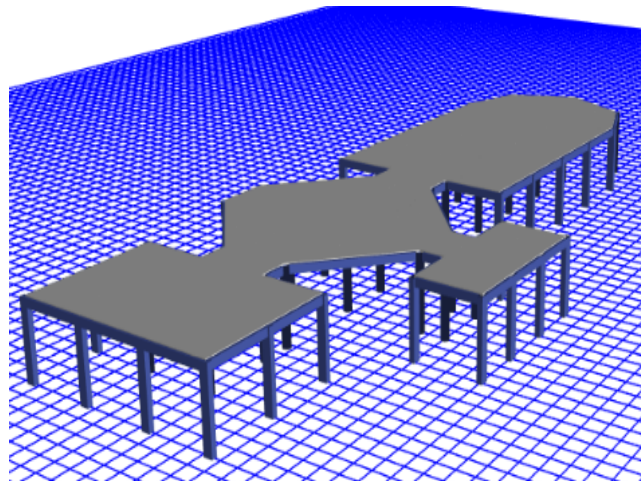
Modelo en ETABS de la sección 2 de la estructura.
